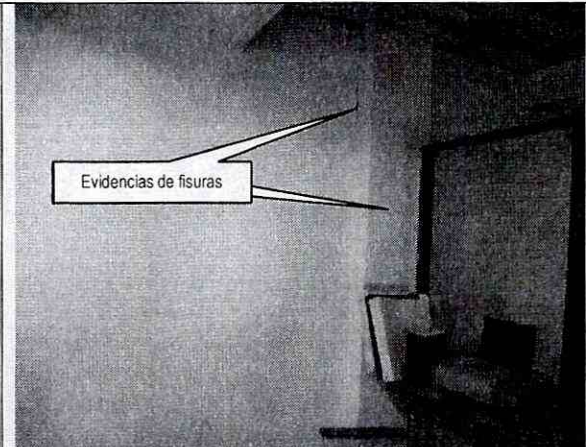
Vista de una de las oficinas del segundo nivel de la edificación emplazada en el predio de la Carrera 116 No. 17-90, donde se observan fisuras en columnas y muros.
